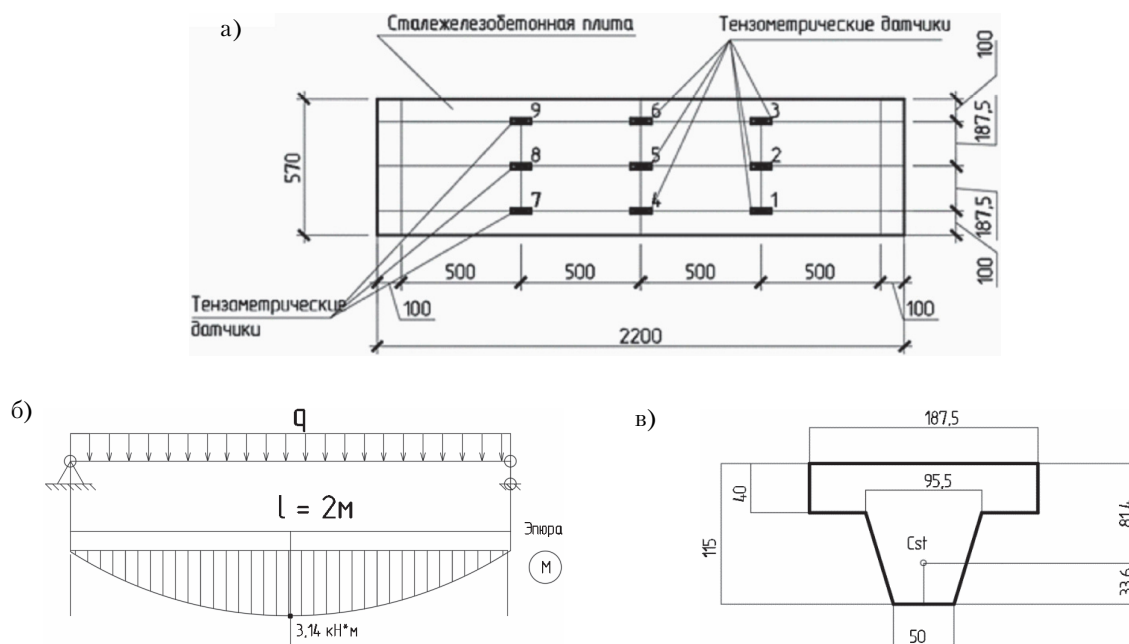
Сталежелезобетонная плита перекрытия: а) схема расположения тензометрических датчиков; б) эпюра изгибающих моментов в плите; в) расчетное поперечное сечение сталежелезобетонной плиты (все размеры приведены в мм).
